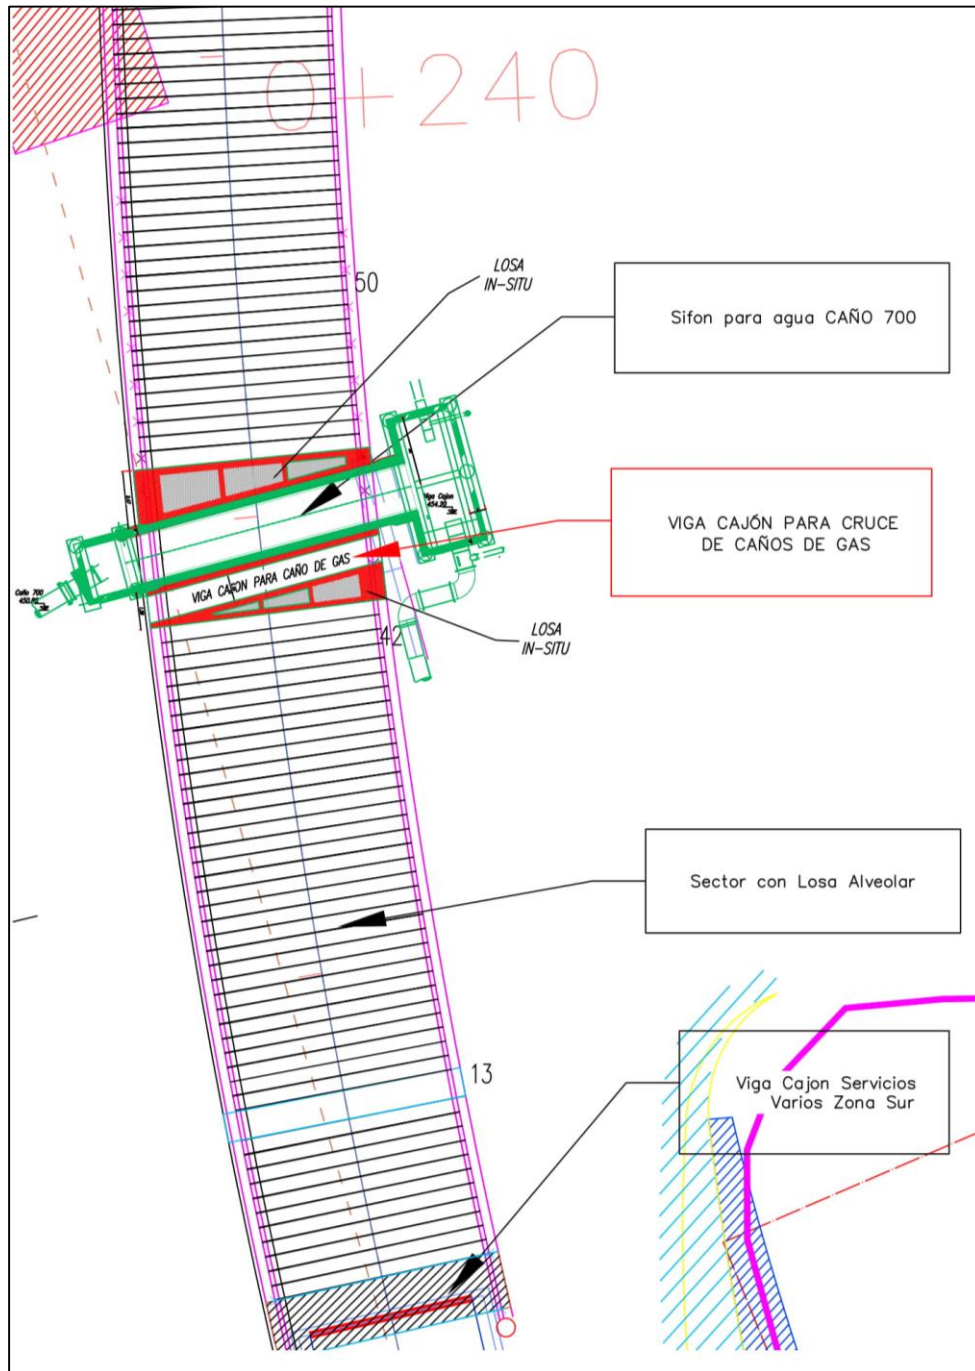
Ubicación de la viga cajón del gas en zona sur. (PLANO N°19)
